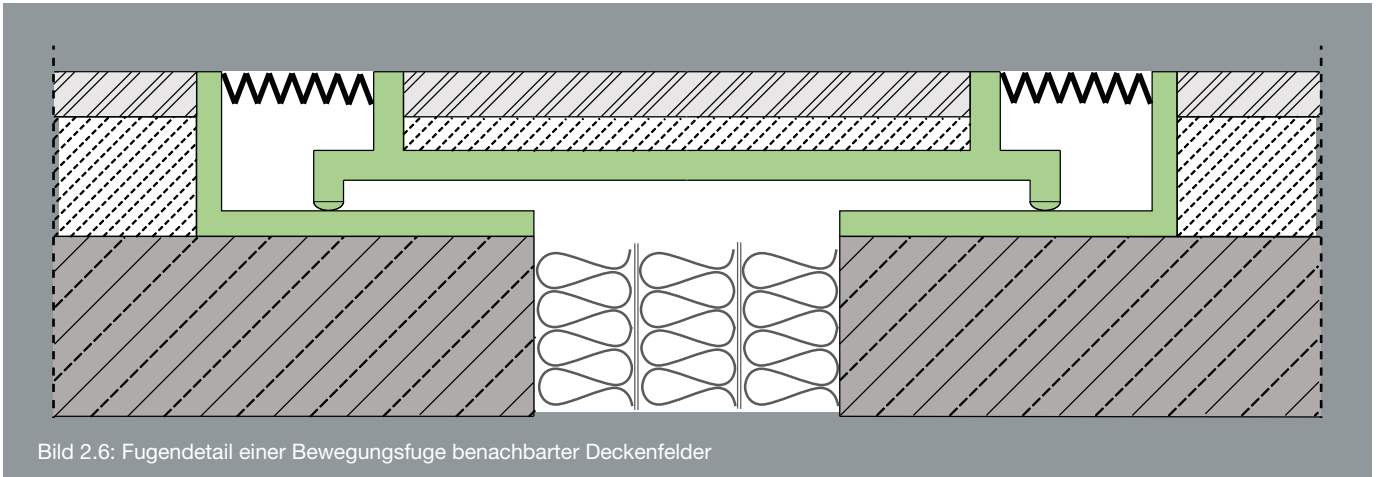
Fugendetail einer Bewegungsfuge benachbarter Deckenfelder
